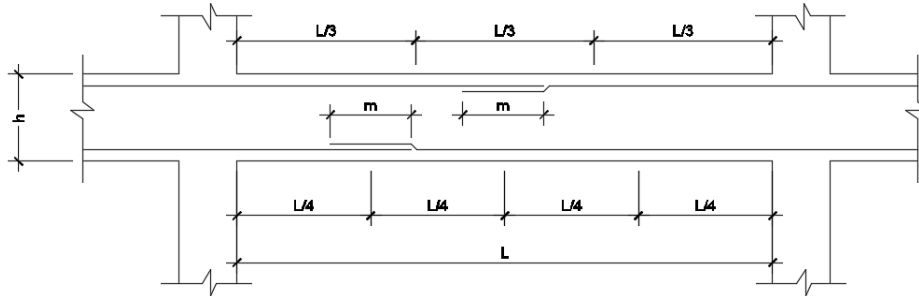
Empalmes traslapados para vigas peraltadas (Blanco, 1994)
